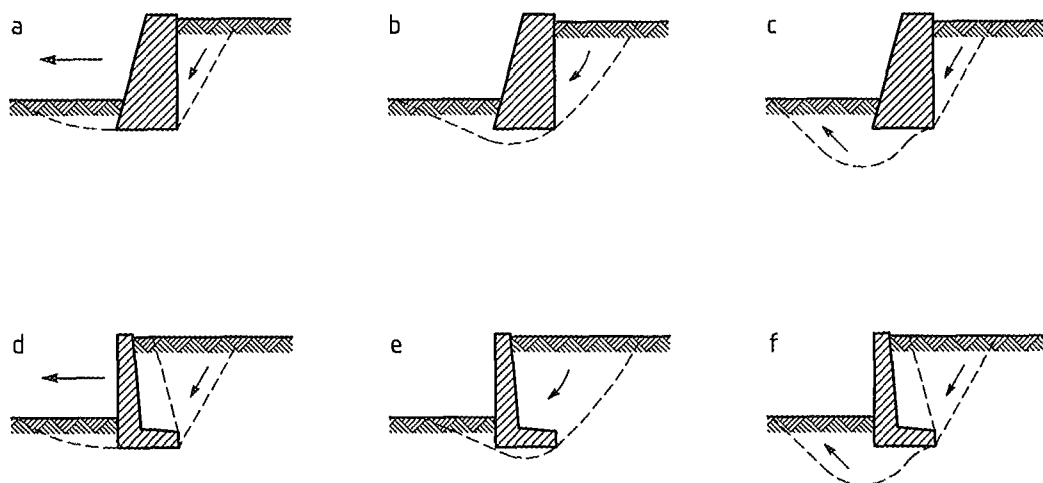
Beispiele für ein Fundamentversagen bei Gewichtsstützwänden
